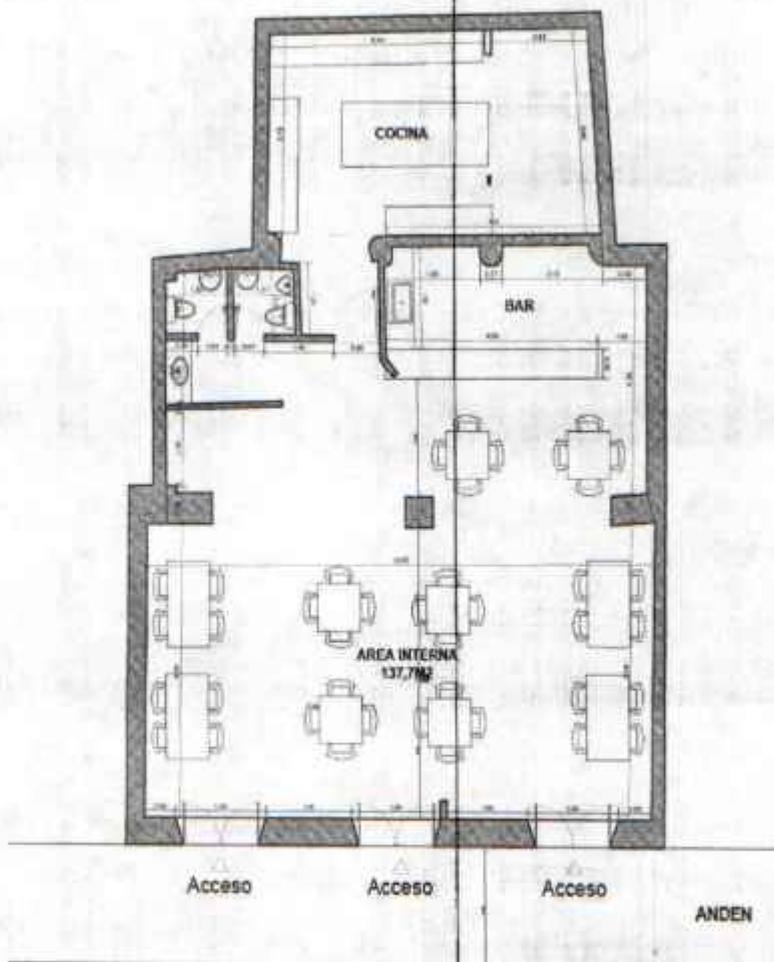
Plano RESTAURANTE ATAHUALPA -Área privada
